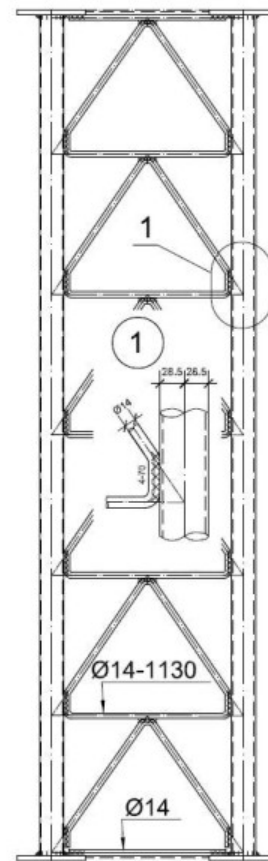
Схема усиления секций / Scheme of reinforcement of sections
